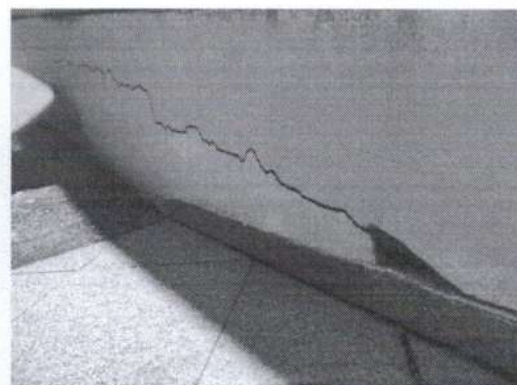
Trinca horizontal localizada na fachada – trechos de alvenarias desconectadas
